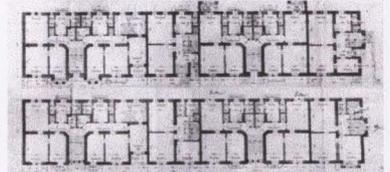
Grundrisse Parterre u. 1. Stock Bachmann-Kolonie, Wegenergasse
